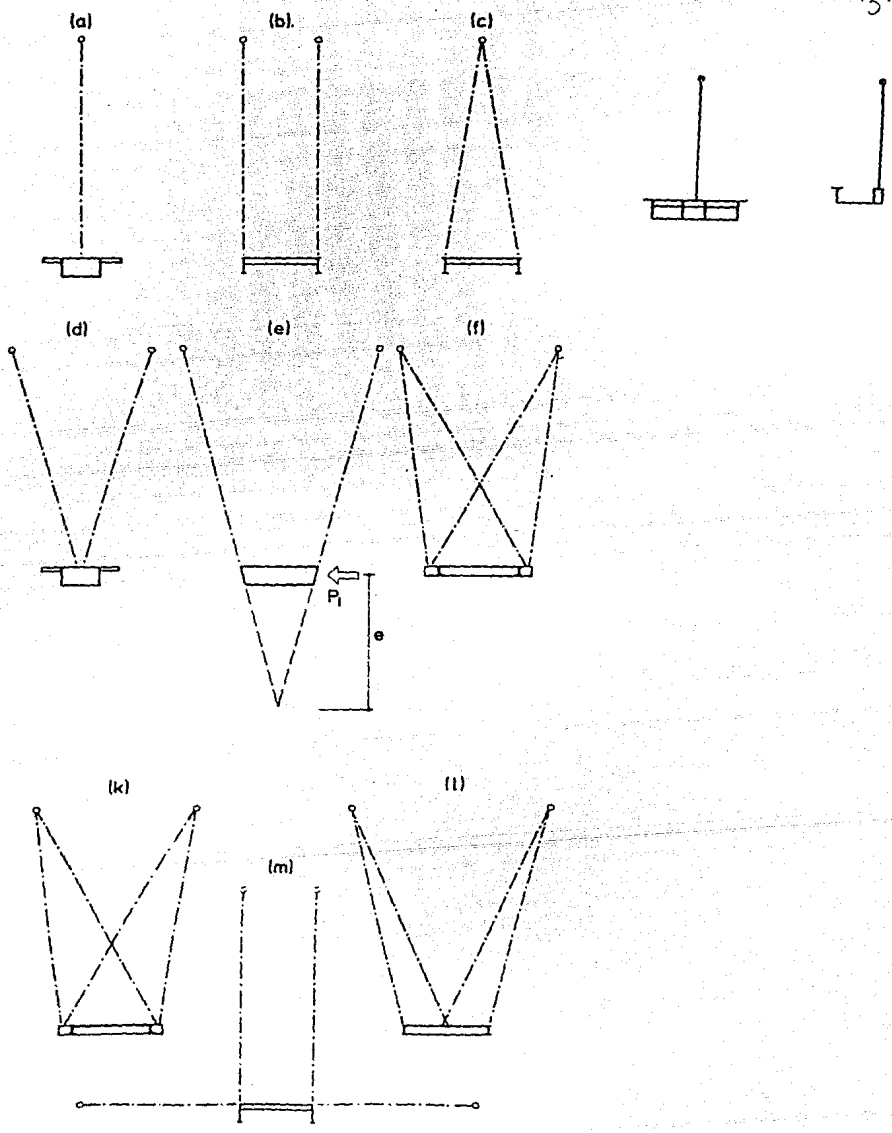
ARREGLOS DE PLANOS DE CABLES.
